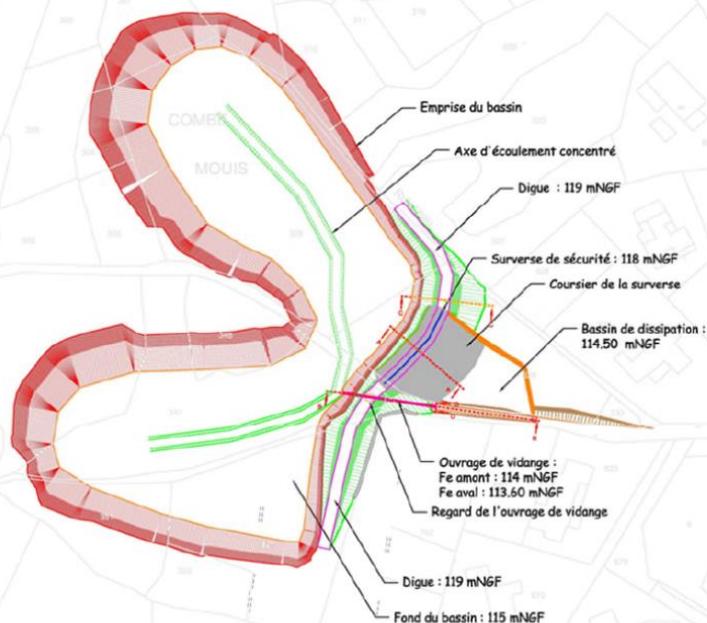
PLAN DU BASSIN D'ECRETEMENT DE COMBEMOUISE
